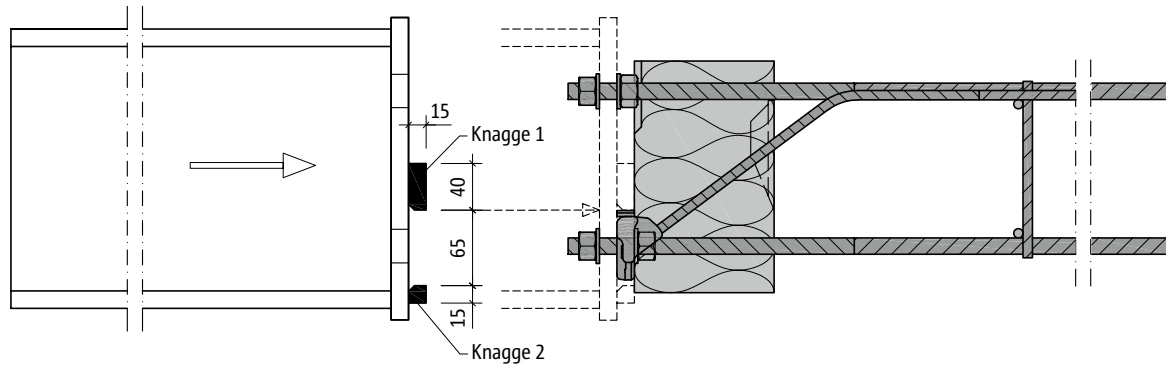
Schöck Isokorb® XT Typ SK: Montage des Stahlträgers
